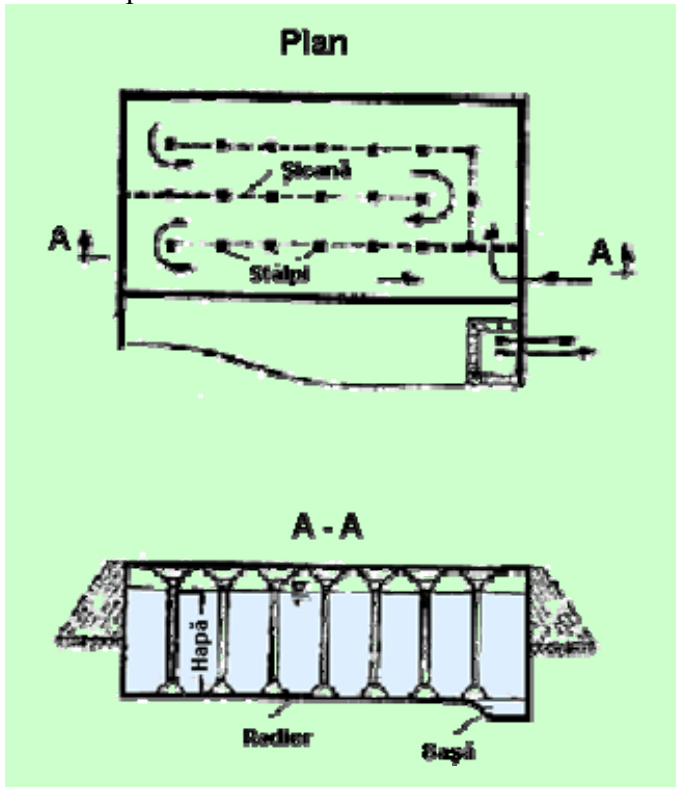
Rezervor cu planșeu ciupercă (vedere plan și secțiune verticală)
